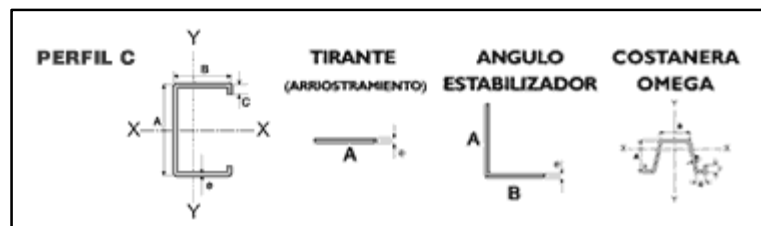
Tipos de perfiles estructuras de Metalcon.-
